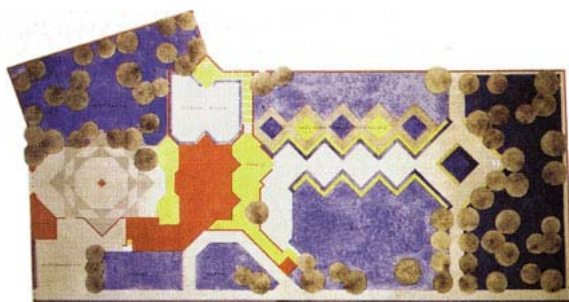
Jardim da Casa Kallenbach - planta baixa - 1922
